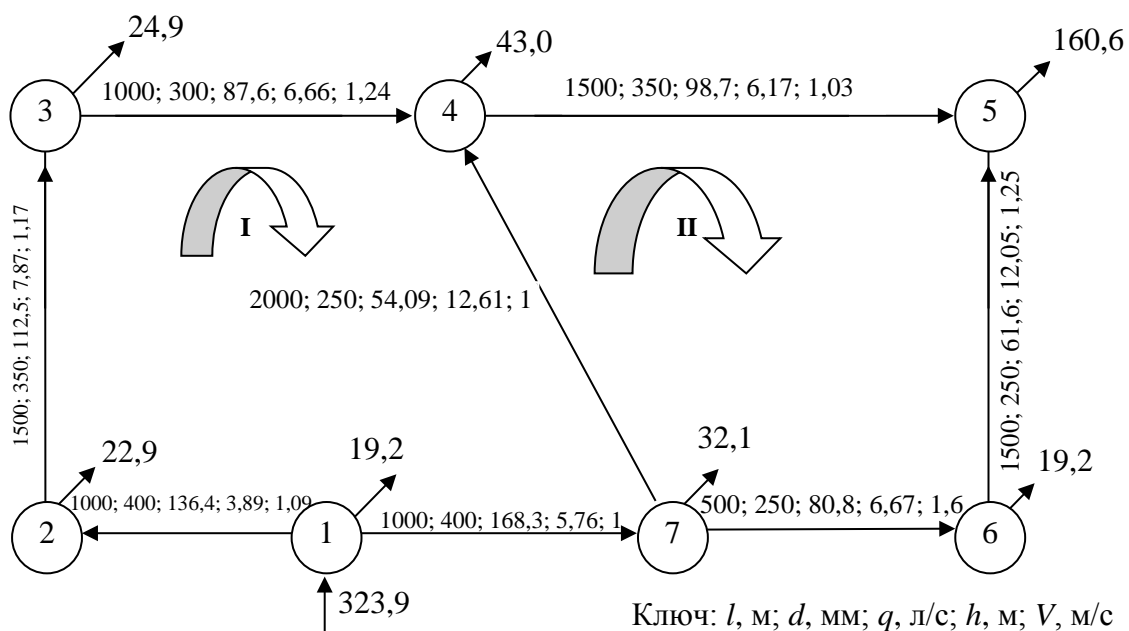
Расчетная схема водопроводной сети с окончательно распределенными расходами воды при пожаре
